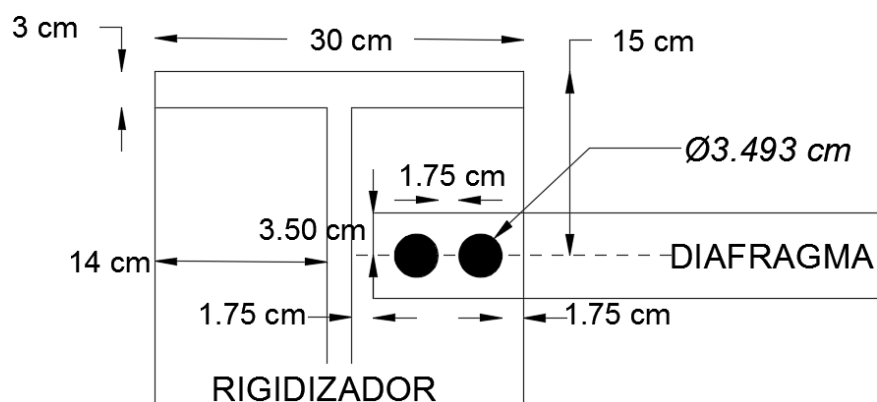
Vista conexión rigidizador transversal de apoyo y contraviento horizontal. Realizado por: Autor
